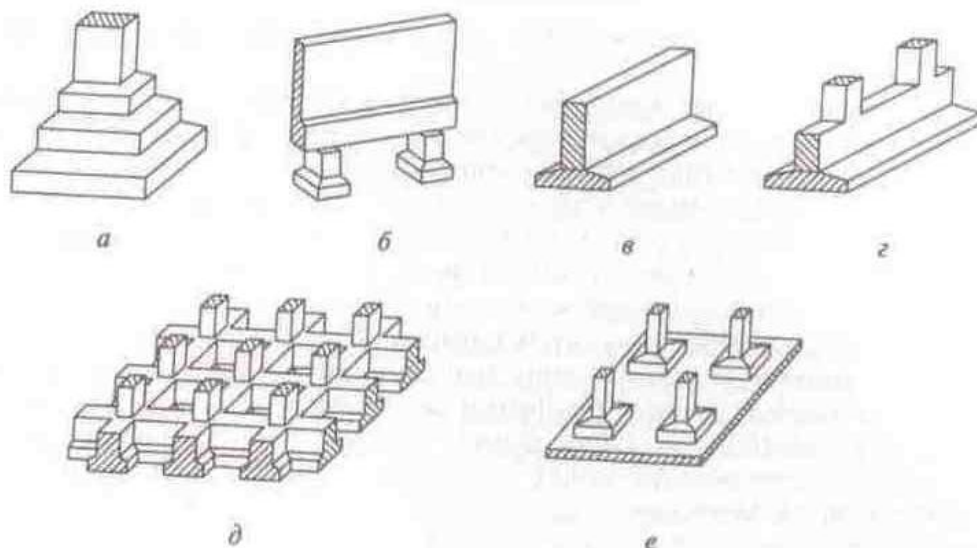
Основні типи фундаментів мілкого закладання: а – окремий фундамент під колону; б – окремі фундаменти під стіну; в – стрічковий фундамент під стіну; г – теж, під колону; д – суцільний (плитний) фундамент
